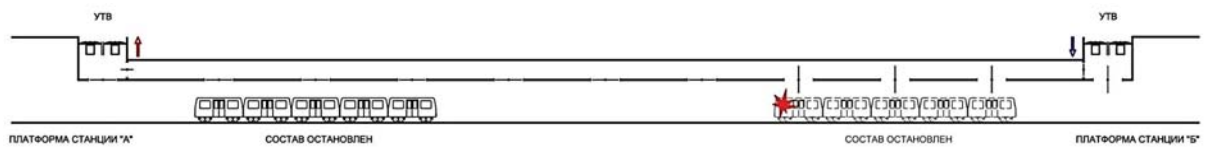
Продольно-поперечная схема противодымной вентиляции при открытых противопожарных клапанах
